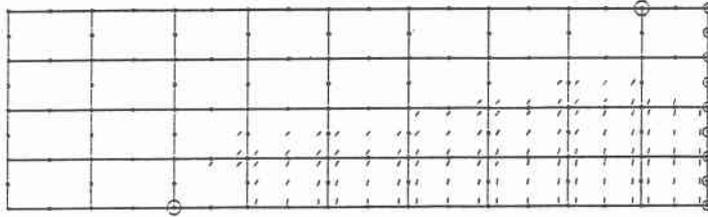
斜めひび割れ発生時のひび割れ性状（静的載荷）
